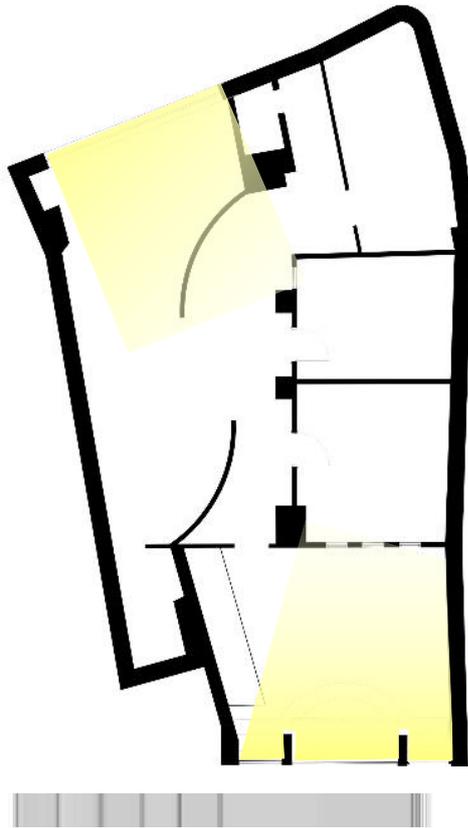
Planta baixa da loja 4 com marcação esquemática das entradas de luz
